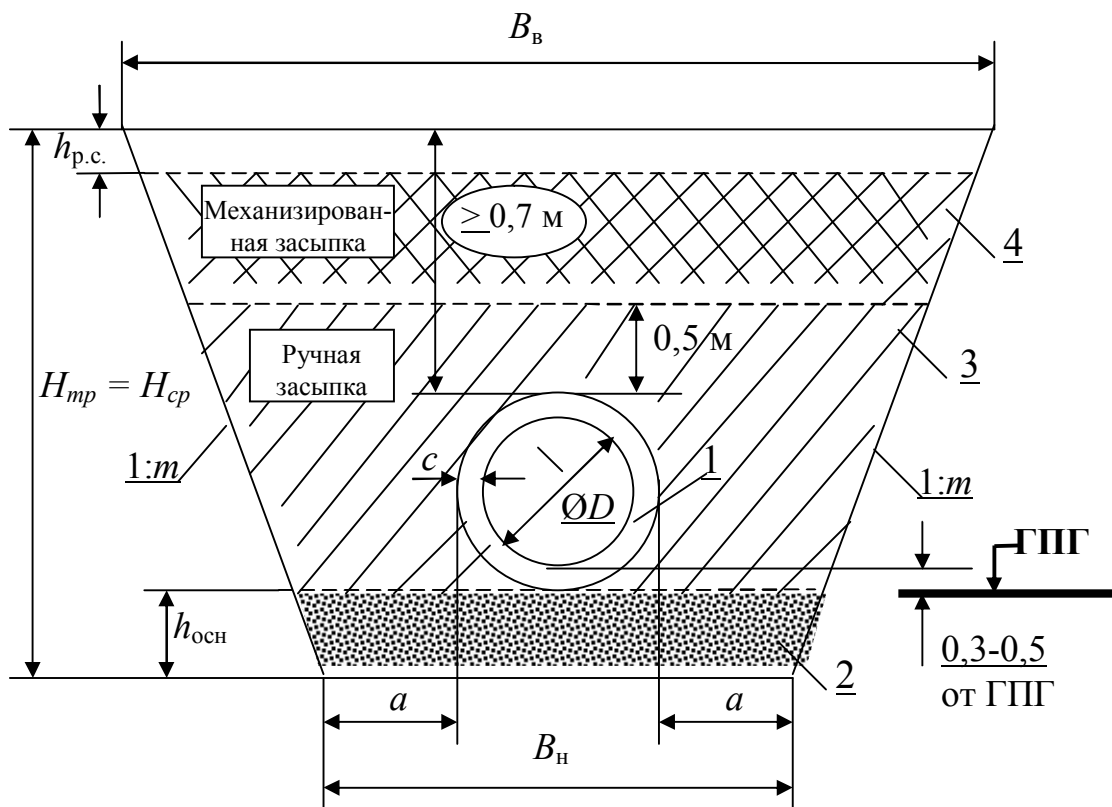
Размеры траншеи и размещение труб: 1 – труба; 2 – основание под трубой; 3 – объем грунта ручной засыпки траншеи; 4 – объем грунта механизированной засыпки траншеи; ГПГ – глубина промерзания грунта
